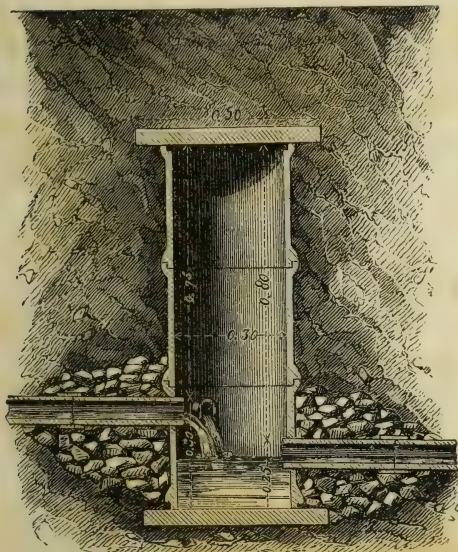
Coupe d'un regard construit avec tuyaux à emboîtement.
